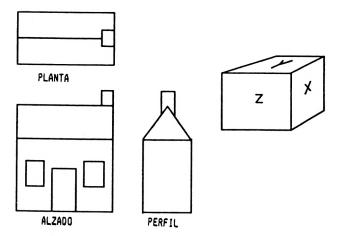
El tipo más sencillo de proyección; un diseño arquitectónico, La planta, el alzado y el perfil se corresponden con los planos perpendiculares a los ejes Z. Y y X.
